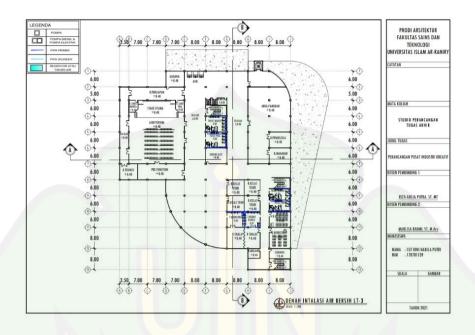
63.Denah Instalasi air bersih lantai 1
